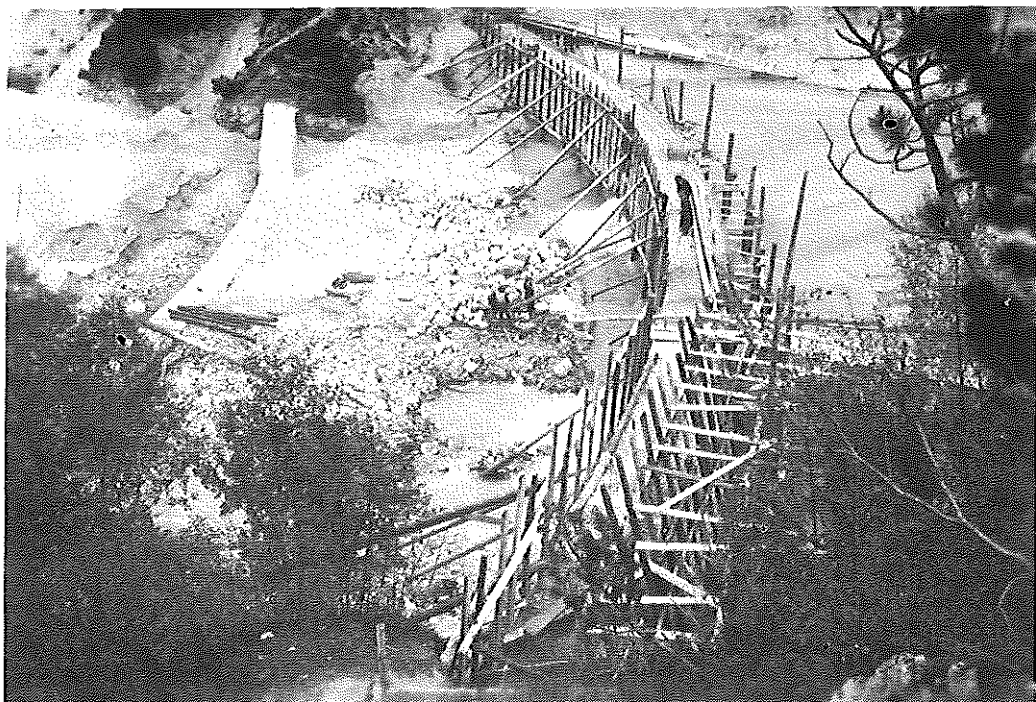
Corso inferiore del torrente Centa: briglia in calcestruzzo armato in fase di costruzione (1912).
